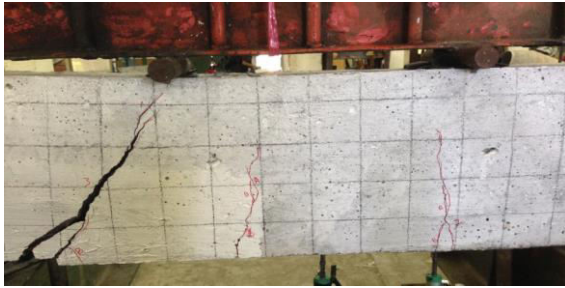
Pola retak balok beton bertulangan bambu tanpa kait
